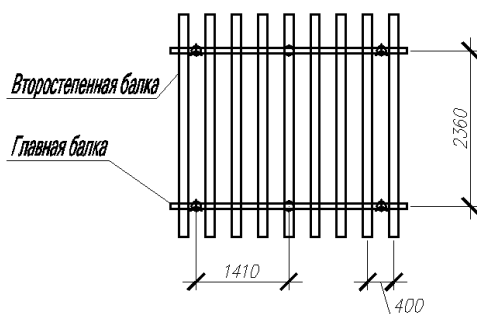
Расстановка стоек и раскладка балок опалубки
